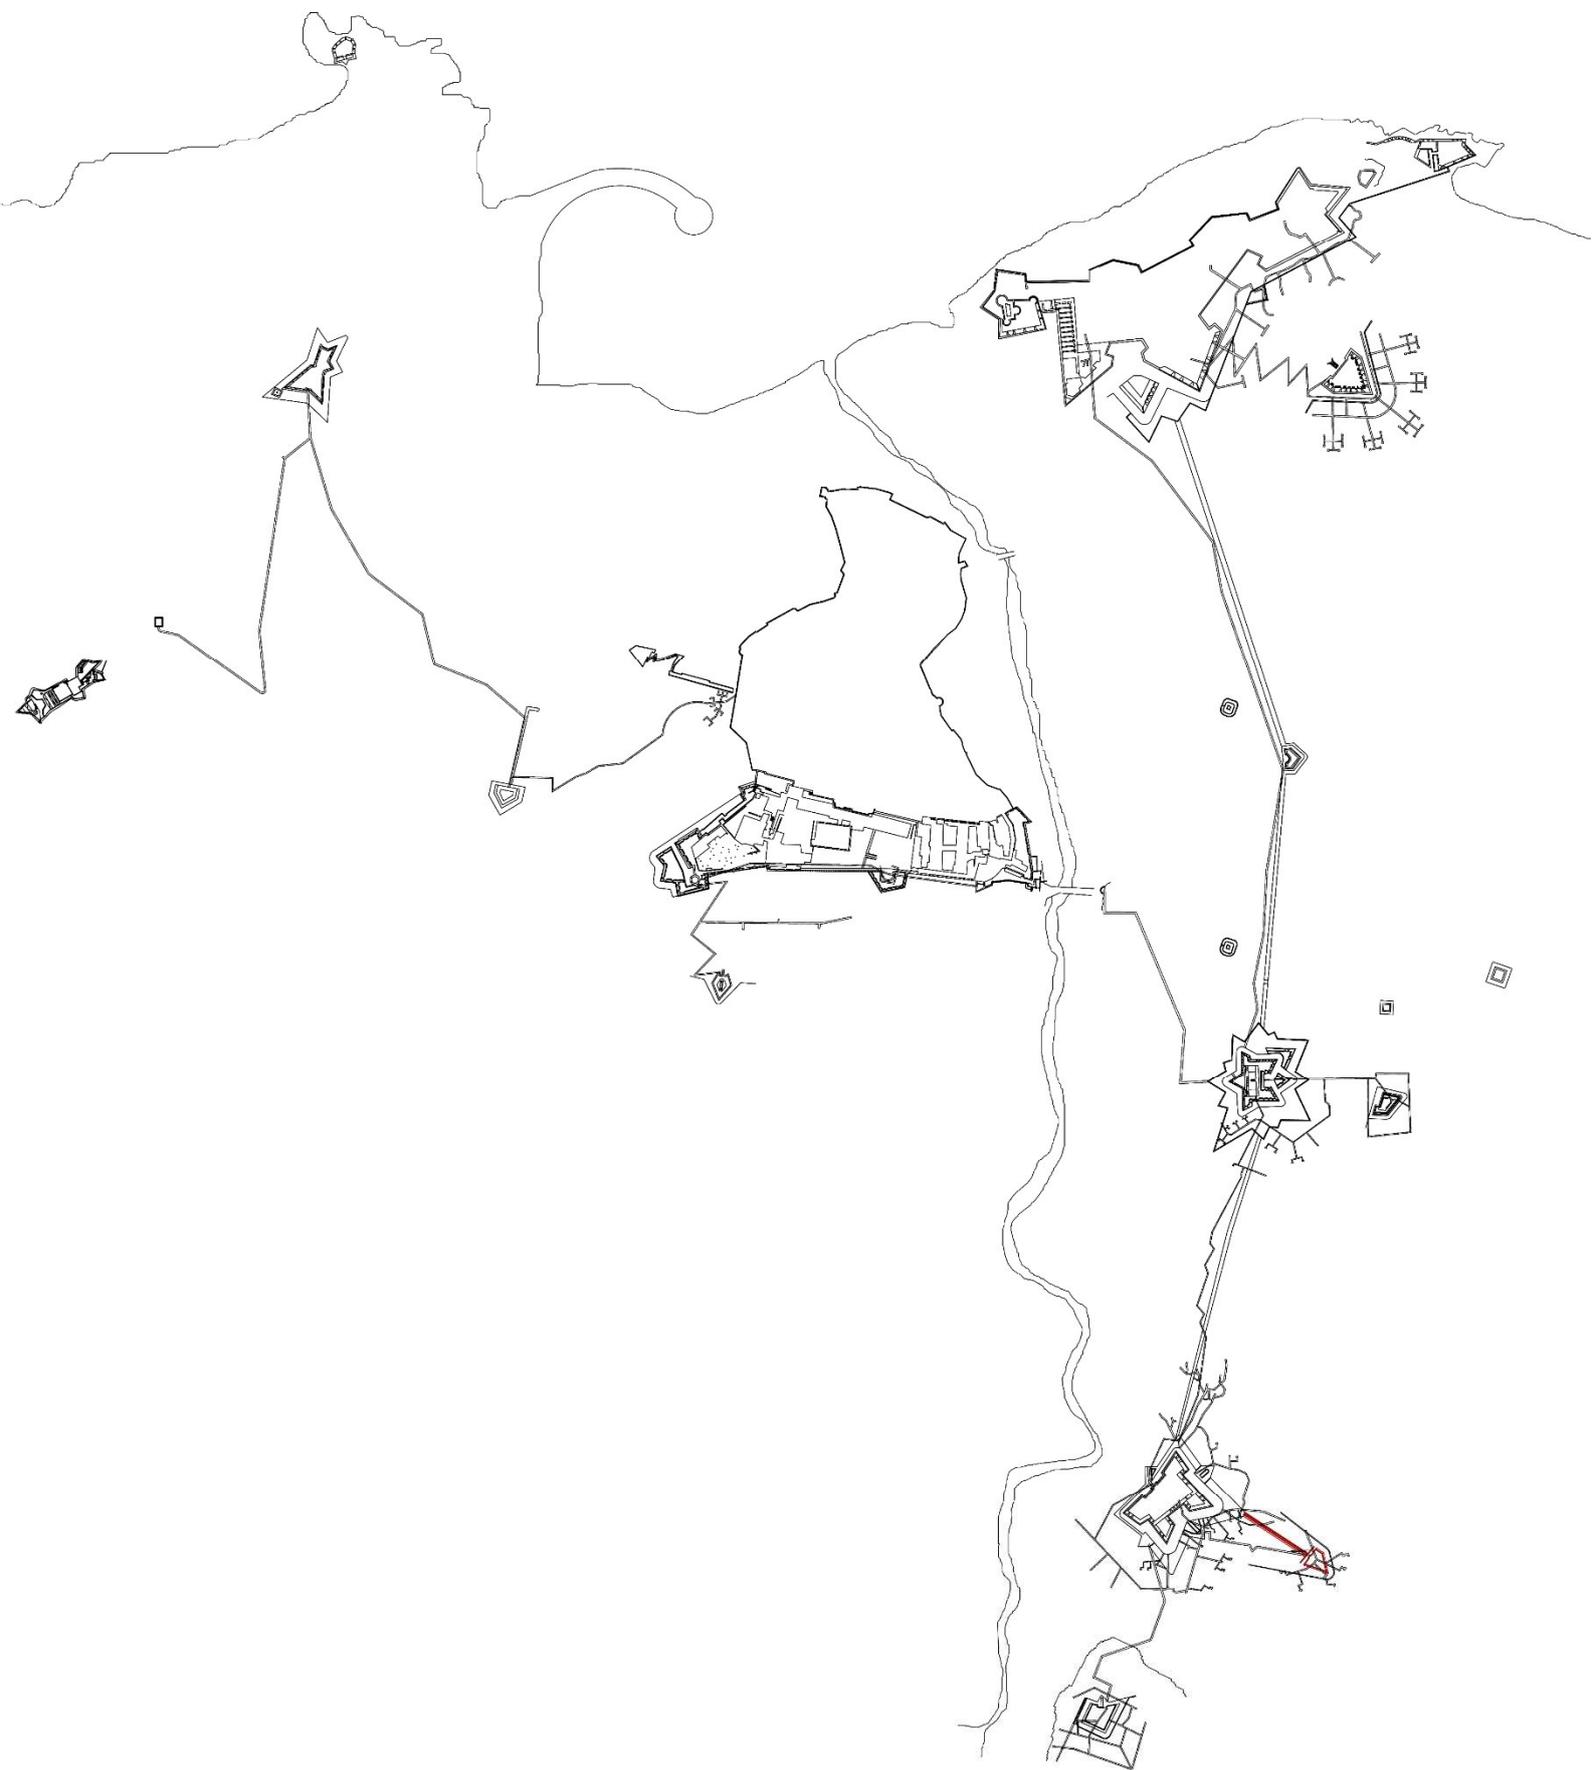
Planta de San Felipe en 1833 (SHD. DGF. Article 8, Section 1, IVH 1320, Carton 11)
